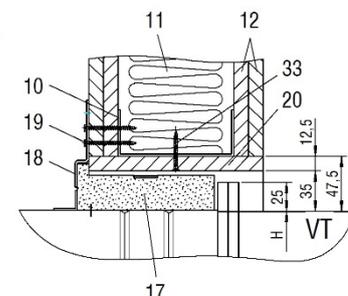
Trockeneinbau mit Einbaurahmen Typ ER-P1 (Schnitt) in leichte Trennwand (F90)
